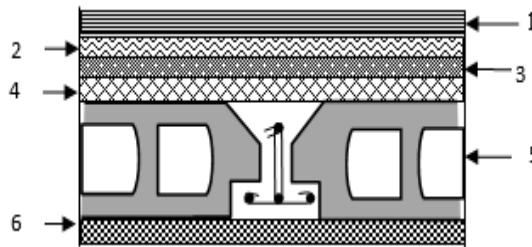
Coupe transversale dans le plancher à terrasse inaccessible
